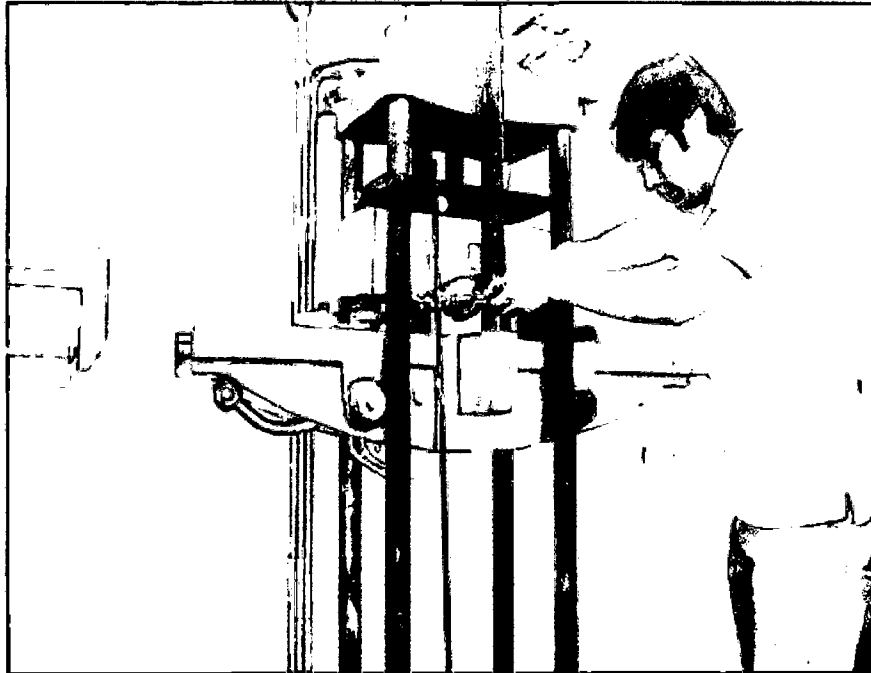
Ensayo a Flexión con las Vigas.
